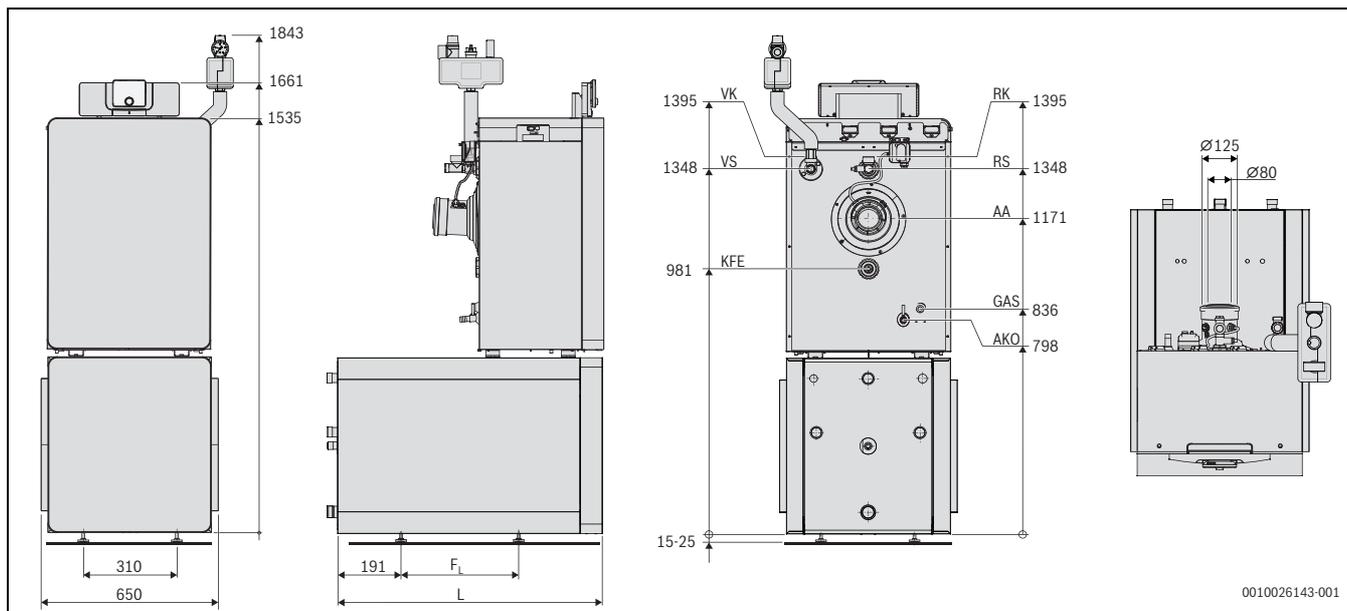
Dimensioni e attacchi GC8000iF con CW400 e WH ...-3 P 2 B (misure in mm)
